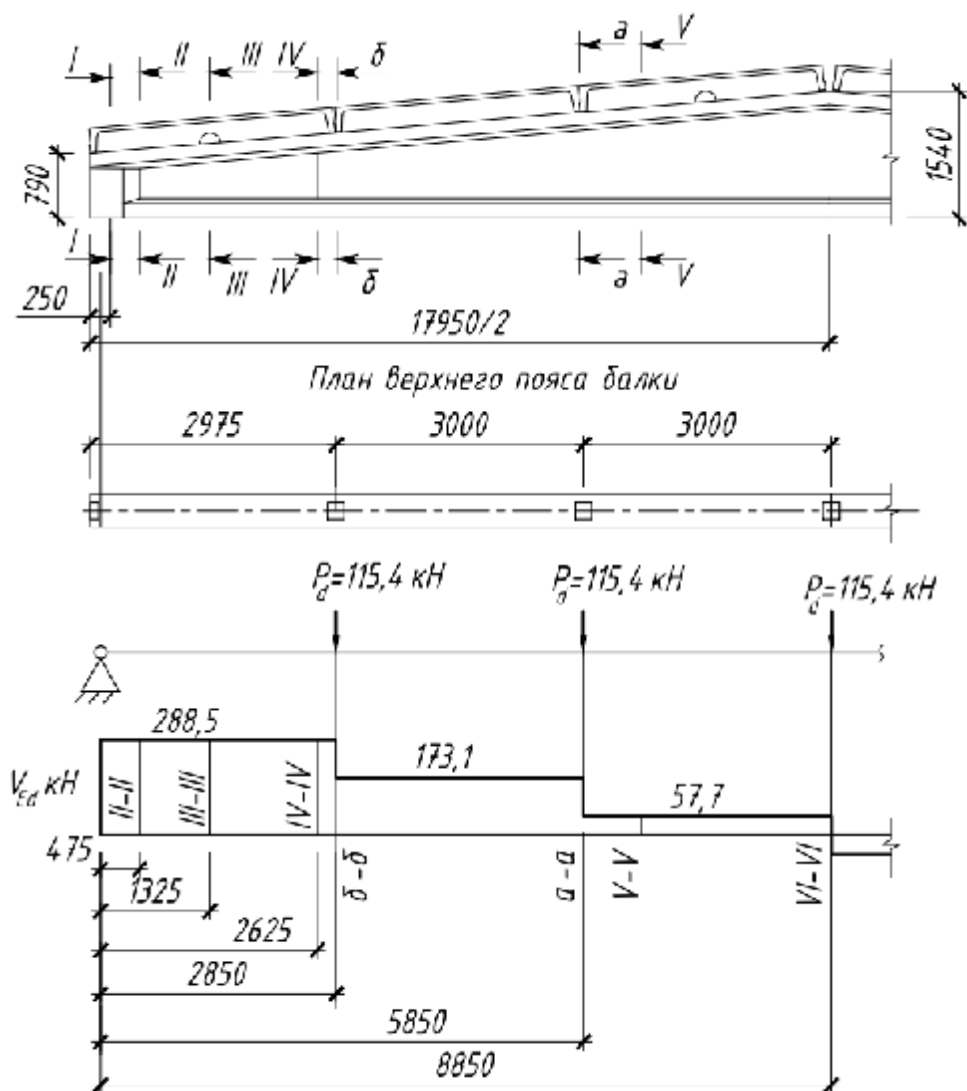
Расчетная схема балки и эпюра поперечной силы  $V_{Ed}$
